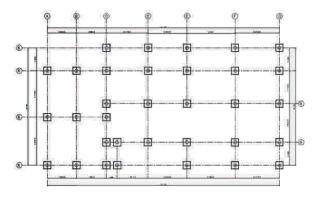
44 : Plano de fundación aislada con pilotes de rollizos de madera de diámetro de 8" a 10", disposición de los cimientos según los ejes respectivos.
